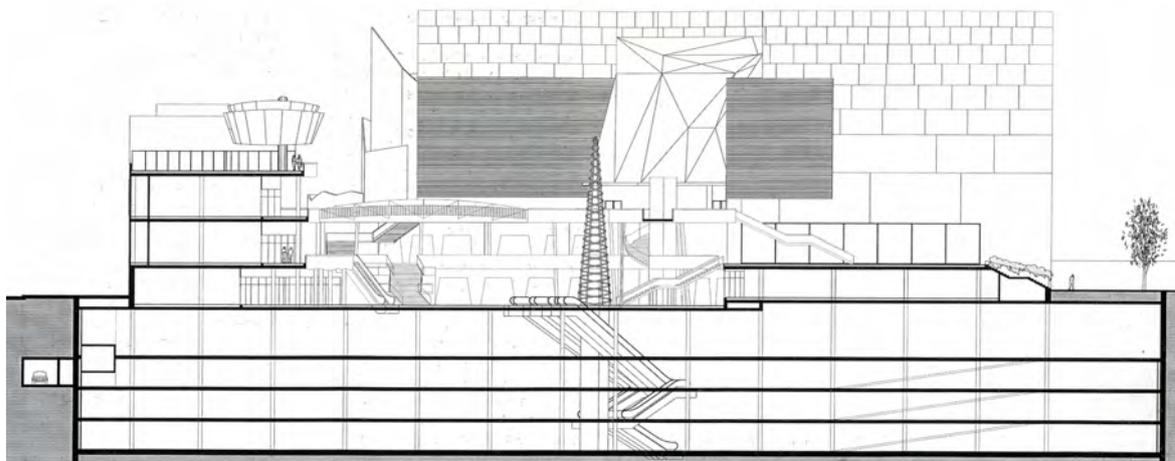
Planta y vista del Espacio Colectivo Centro Heron City
